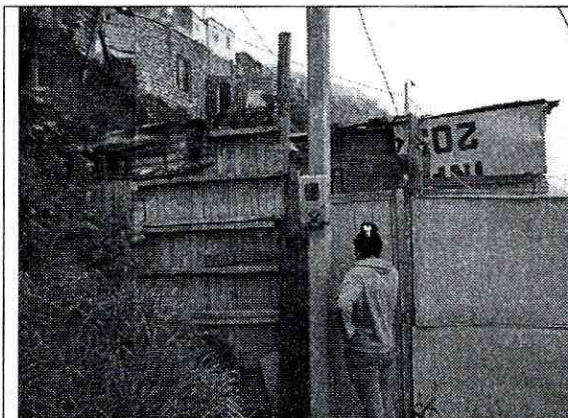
Vista de fachada del predio ubicado en la Calle 81F Sur # 19-28, en este sector no se observan afectaciones.
